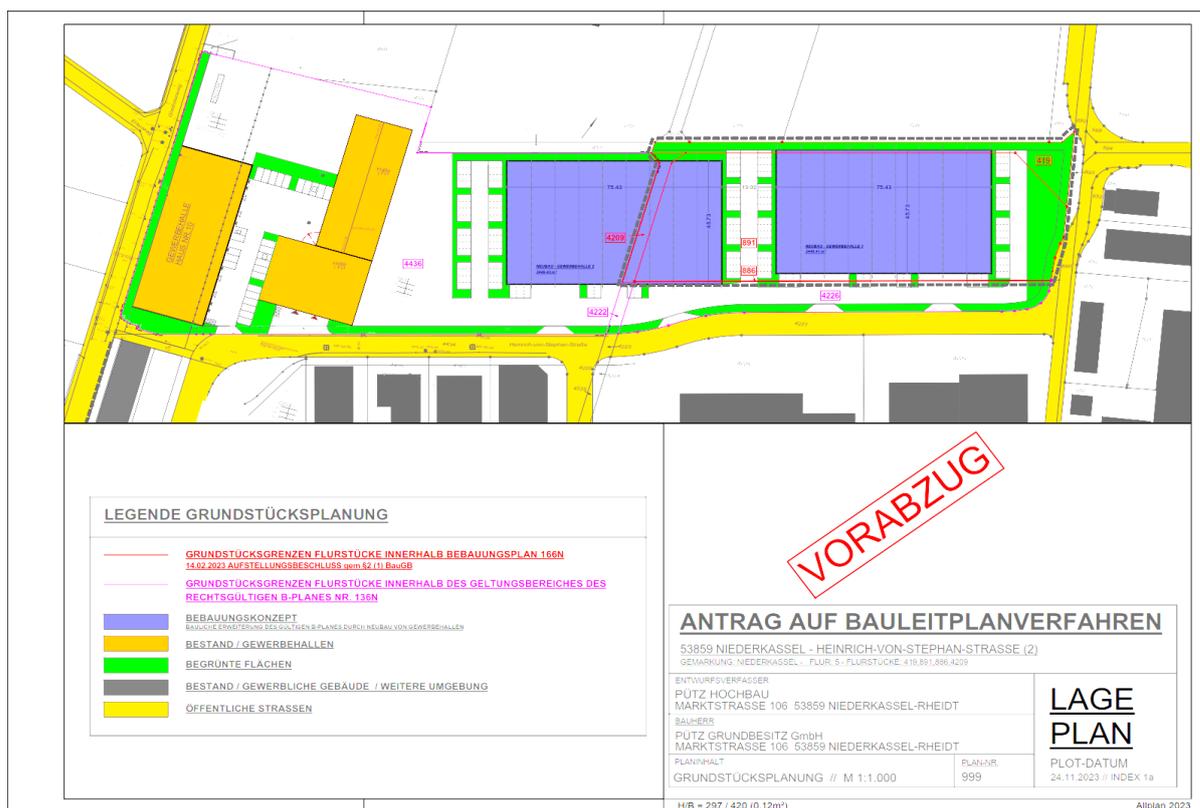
Lageplan - Nutzung der neuen Gewerbeflächen (Quelle: Pütz Grundbesitz GmbH)
